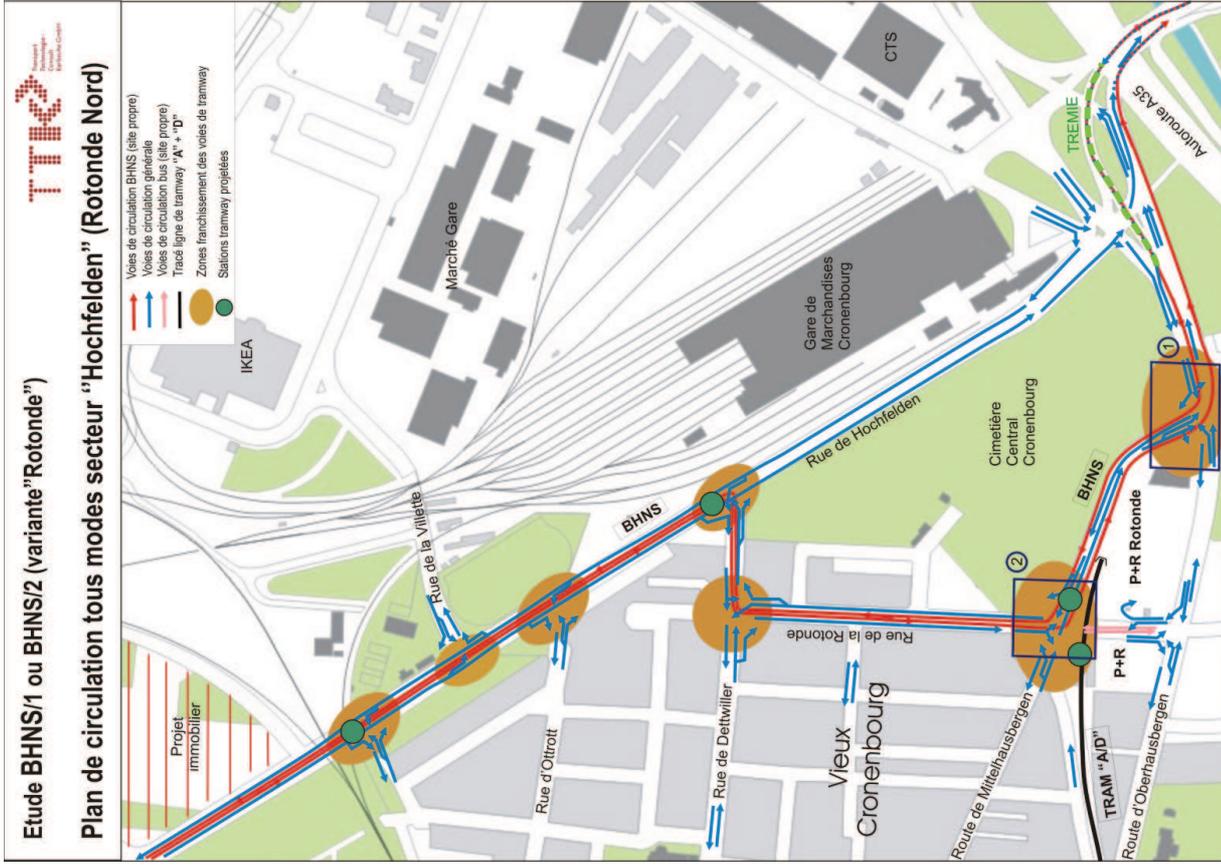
Plan de circulation bus et voiture secteur "Rotonde Nord" (BHNS)
